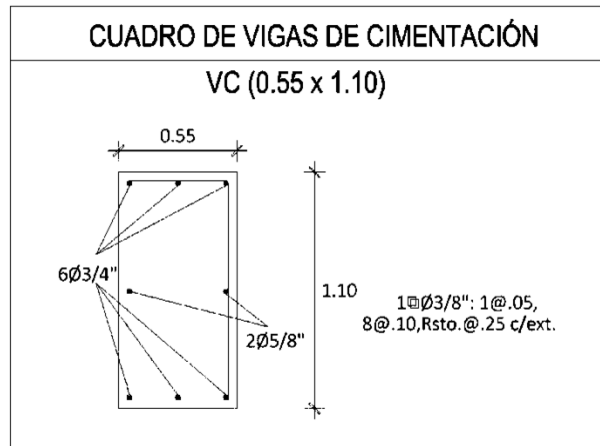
Detalle de Viga de Cimentación Sector de Estudio
